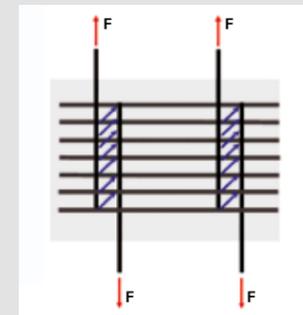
Lastweiterleitung eingemörtelter Stäbe (Spieth, 2002) mit Anschlussbewehrung
